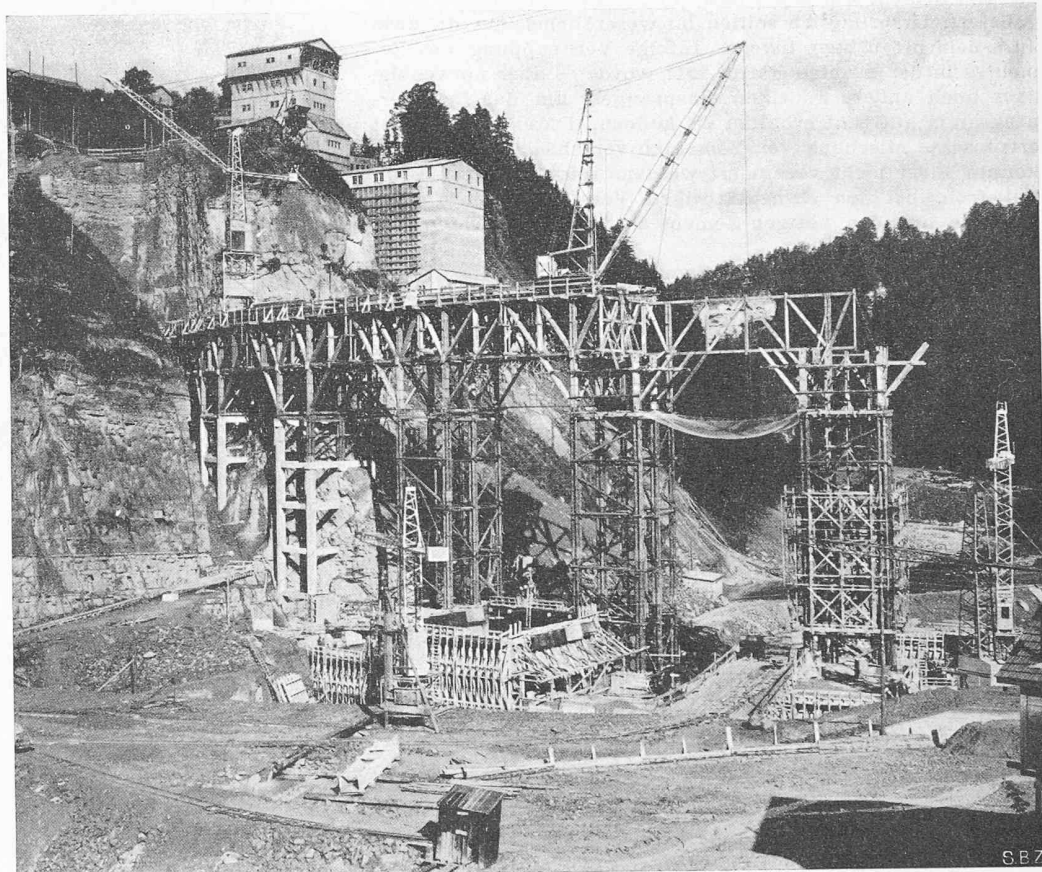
Montage der Dienstbrücke. Stand vom 29. Oktober 1946
